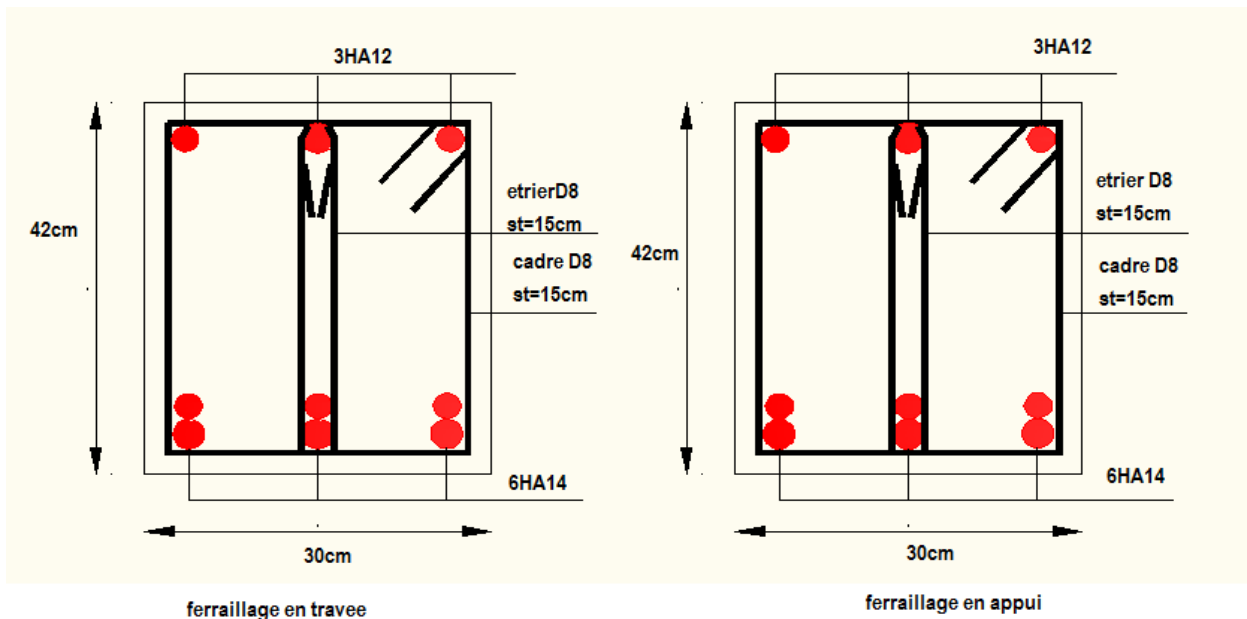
schéma de ferrailage de la poutre de chaînage (1).
